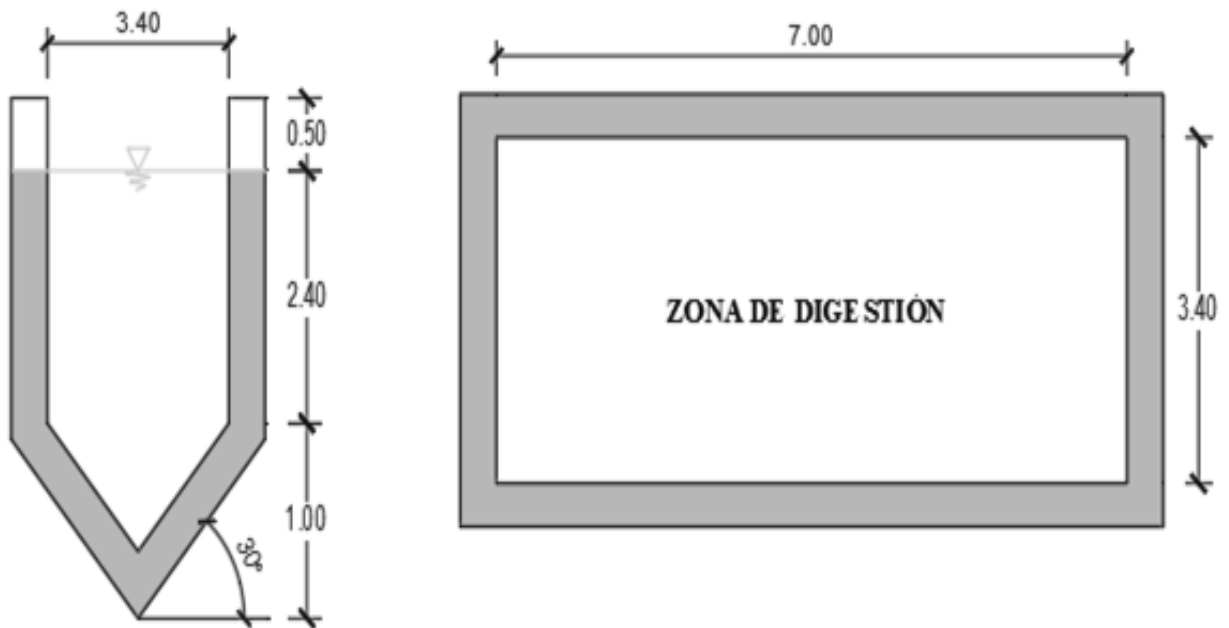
Medidas de la zona de digestión del tanque imhoff vista en perfil y planta
